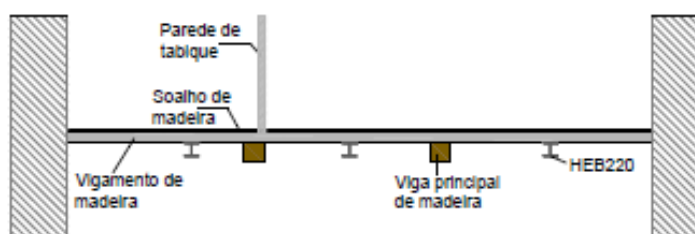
Esquema de instalação de vigamentos metálicos intercalados com os de madeira[36]
